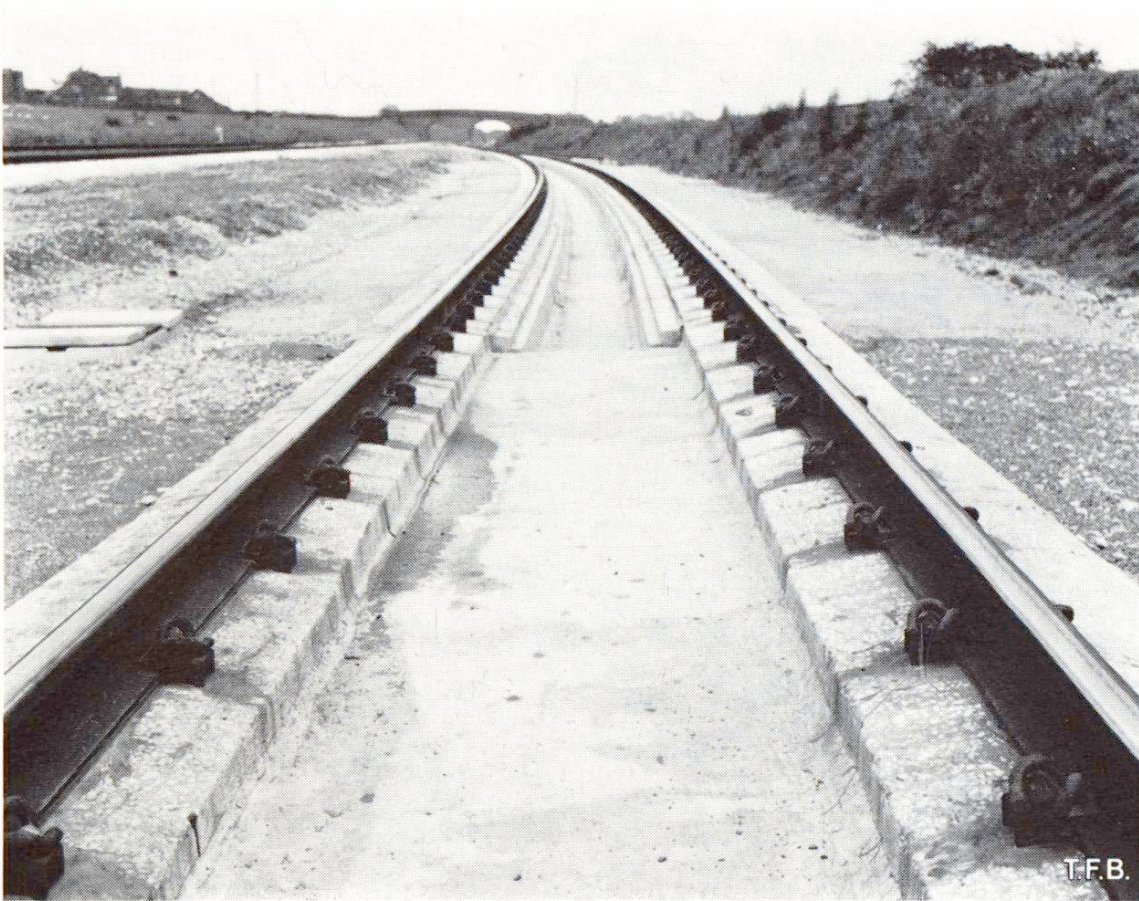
Tronçon d'essai de pose de voie dans le futur tunnel de la Manche.
